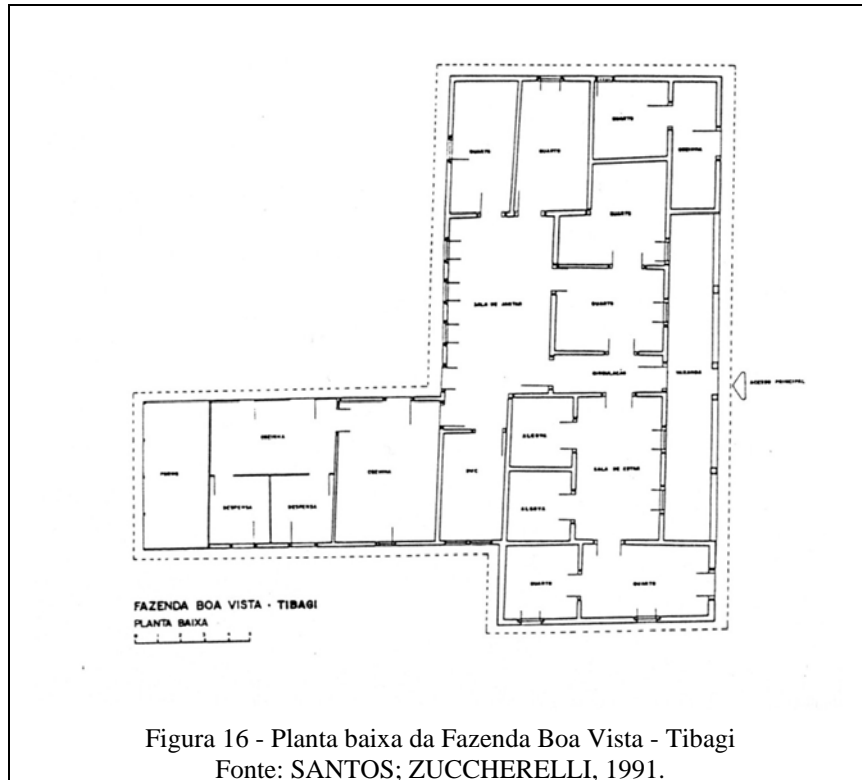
Planta baixa da Fazenda Boa Vista - Tibagi
